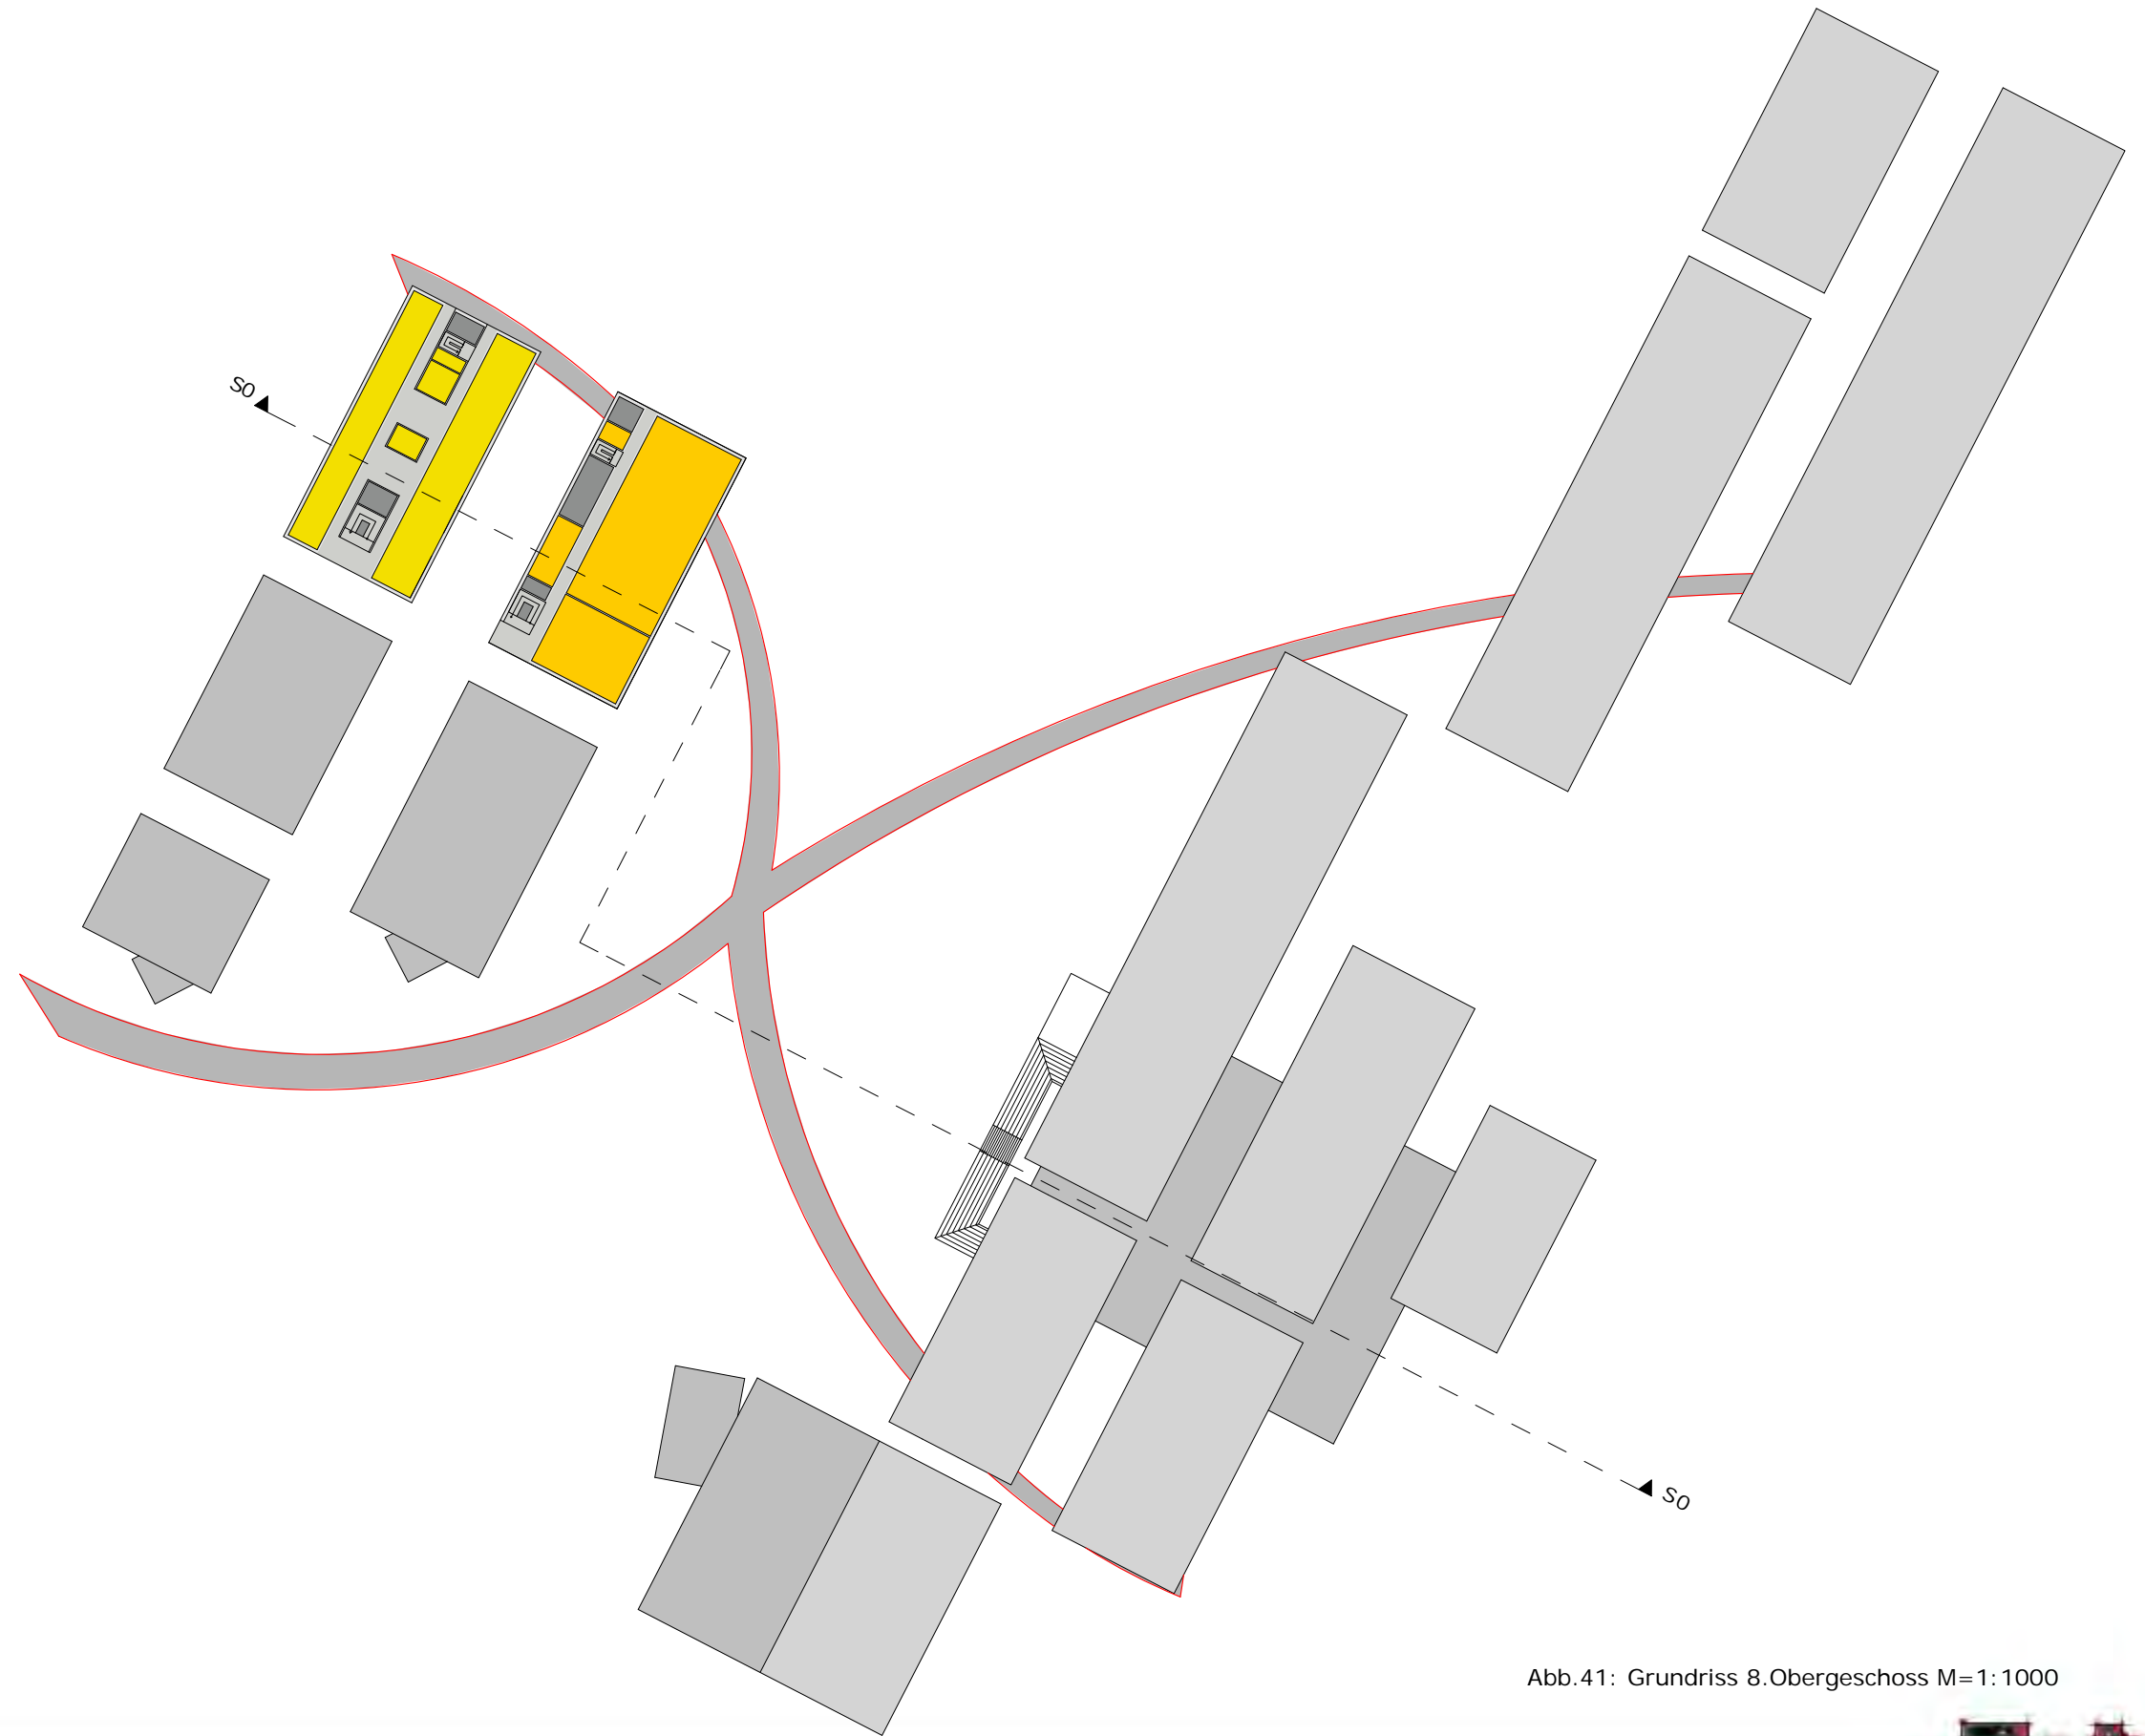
Grundriss 8.Obergeschoss M=1:1000
